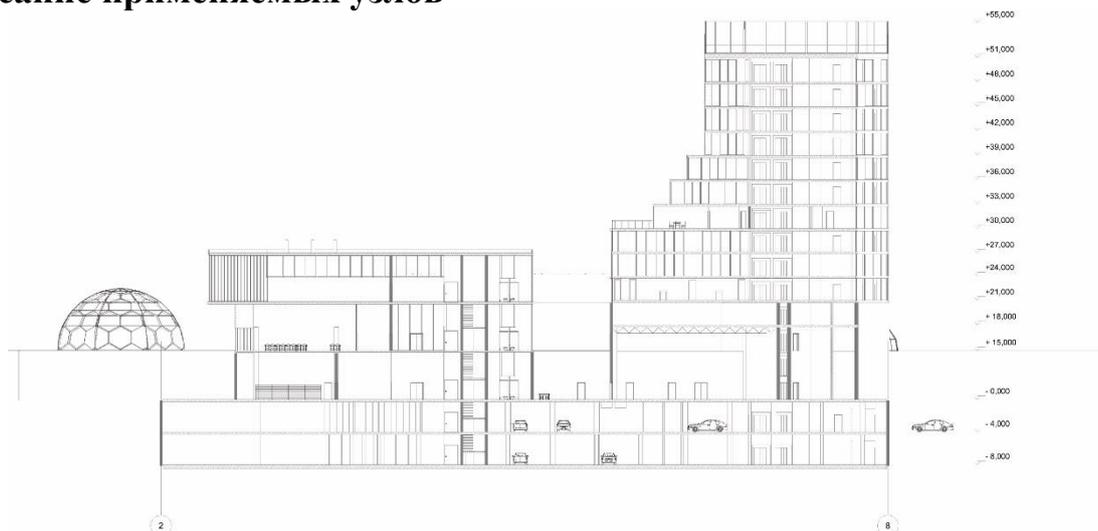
Разрез 1-1 (Чертеж автора)
